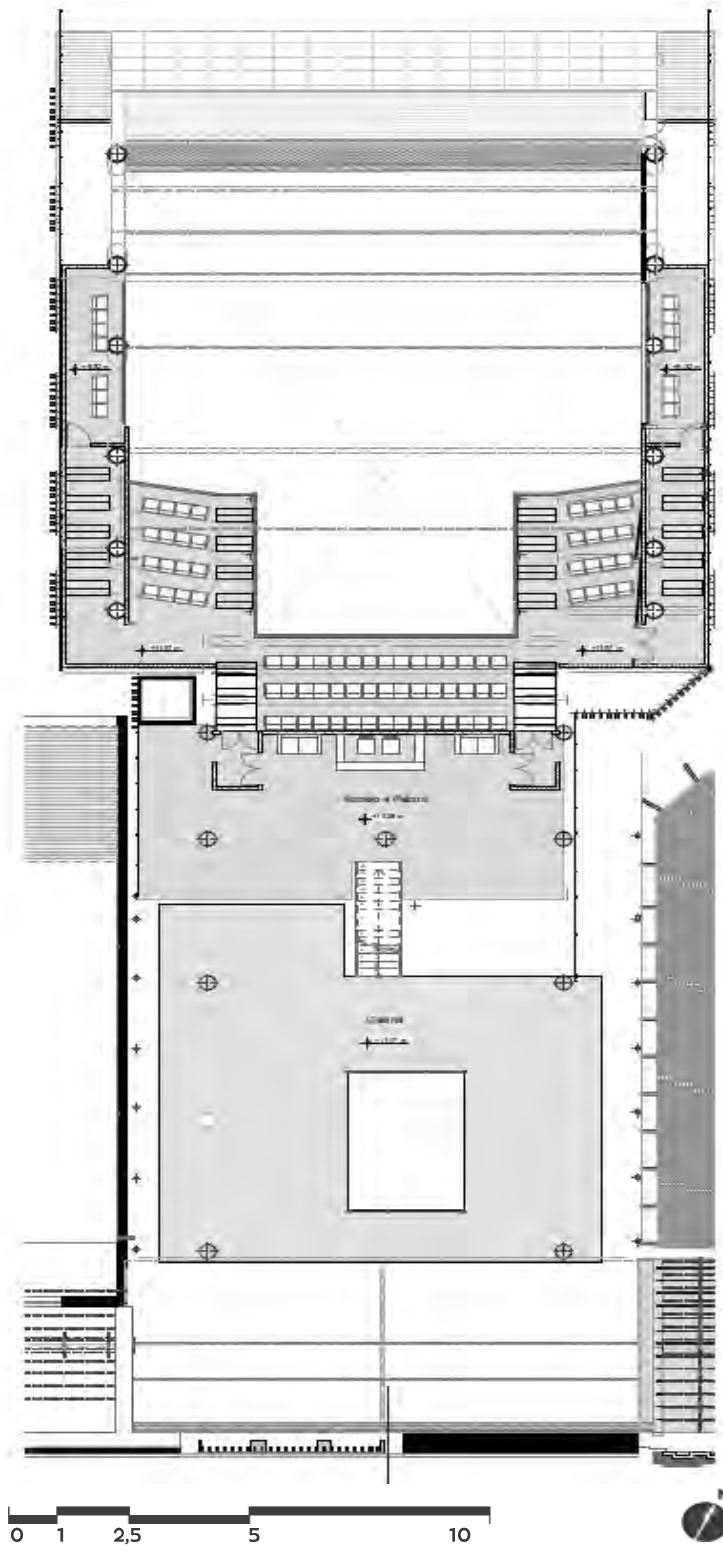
Planta Sala de Música Palcos. Fuente: Elaboración Propia.
